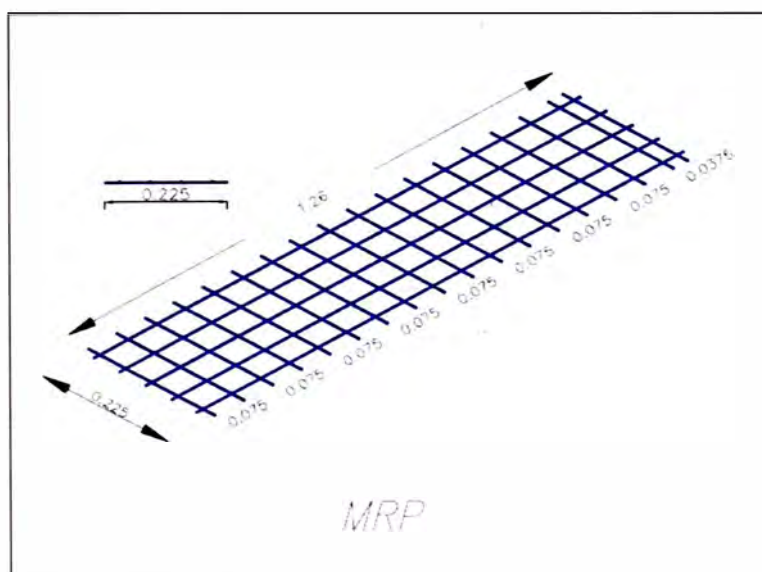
9 .- Mallas de Refuerzo Plana
